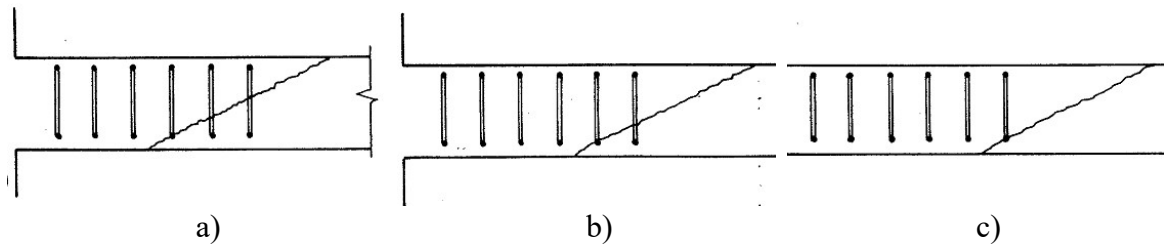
Possíveis localizações da fissura diagonal ao longo da região das armaduras de cisalhamento (REGAN, 2001)
